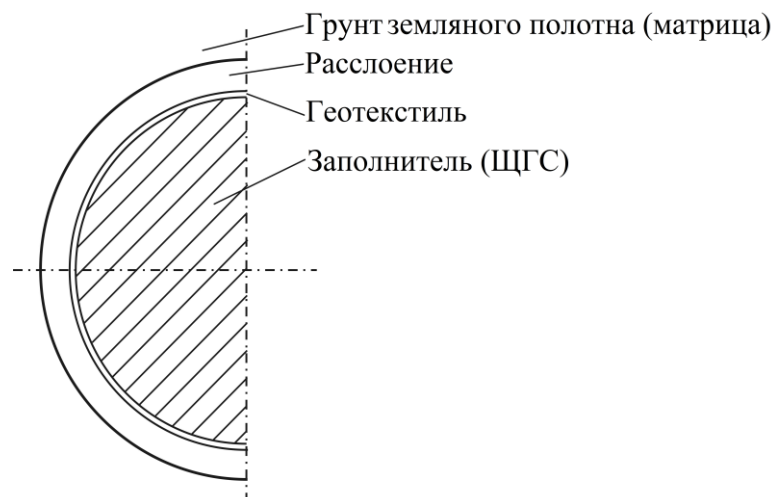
Схема расслоенной полуцилиндрической оболочки
